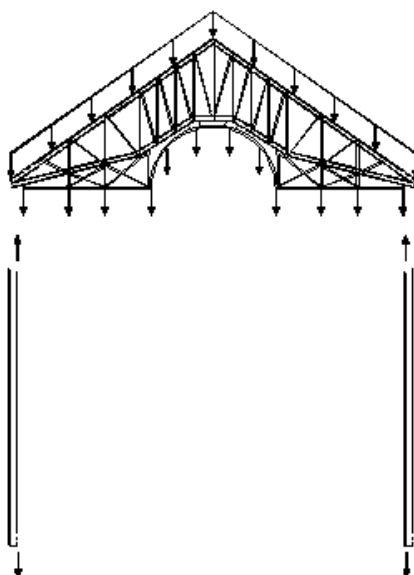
Transmisión de Cargas de las armaduras a muros de mampostería y columnas.
